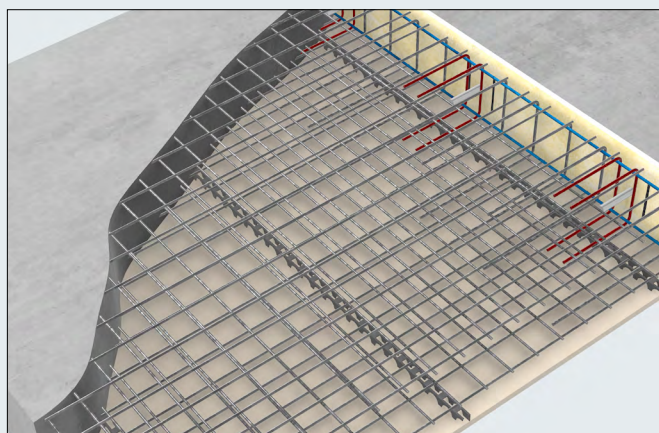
Nach der Bewehrungskontrolle des zweiten Plattenabschnitts die Platte betonieren.
